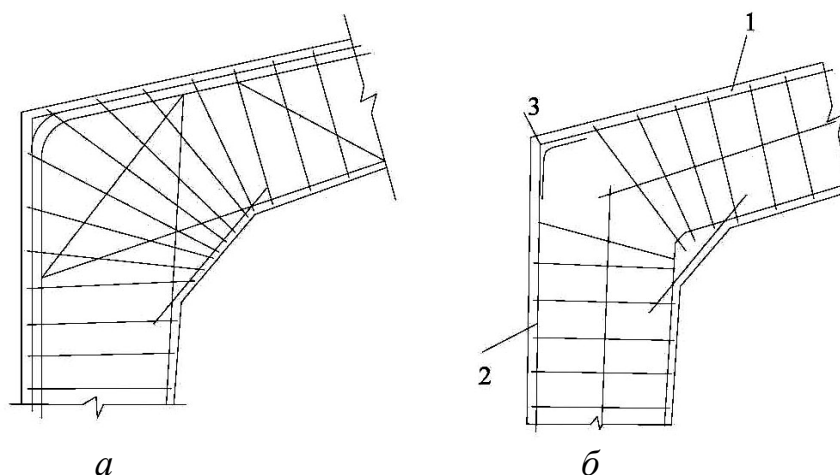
Армирование узла соединения ригеля со стойкой:
